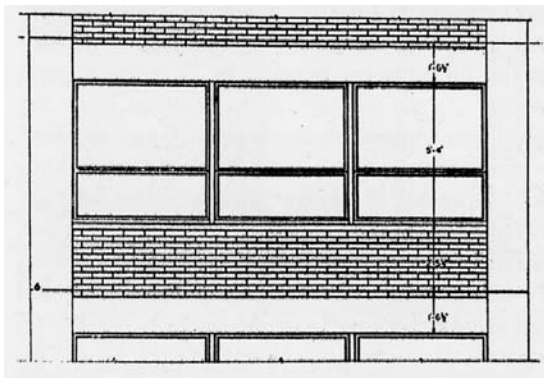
Promontory Apartment Building, Chicago, 1946–1949, Fassade
